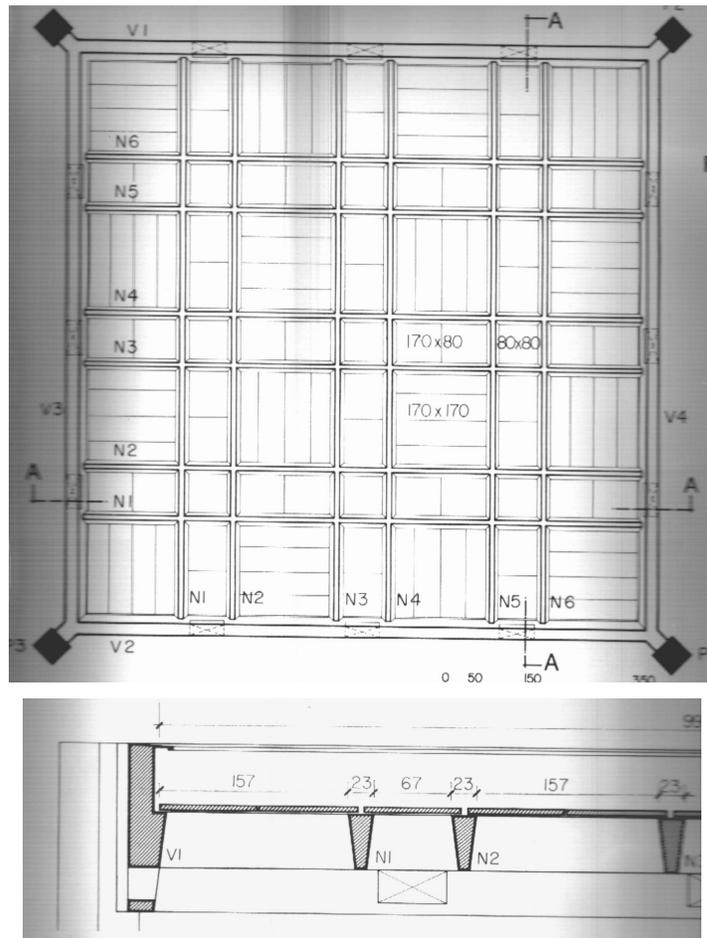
Módulo construtivo mais adotado pela UFMG
